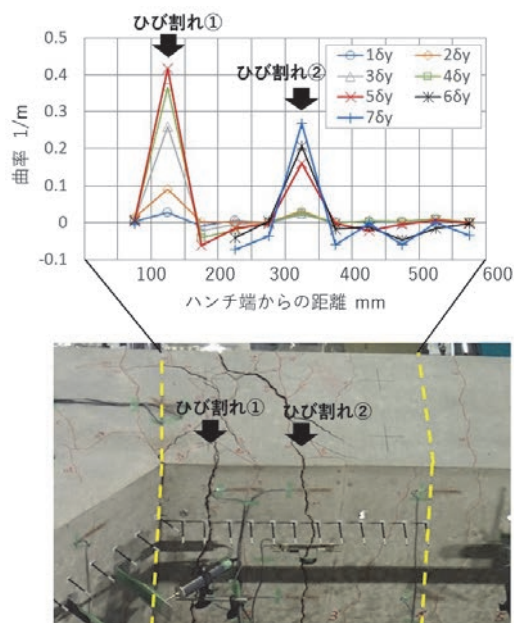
載荷ステップごとの曲率分布とひび割れ発生位置
